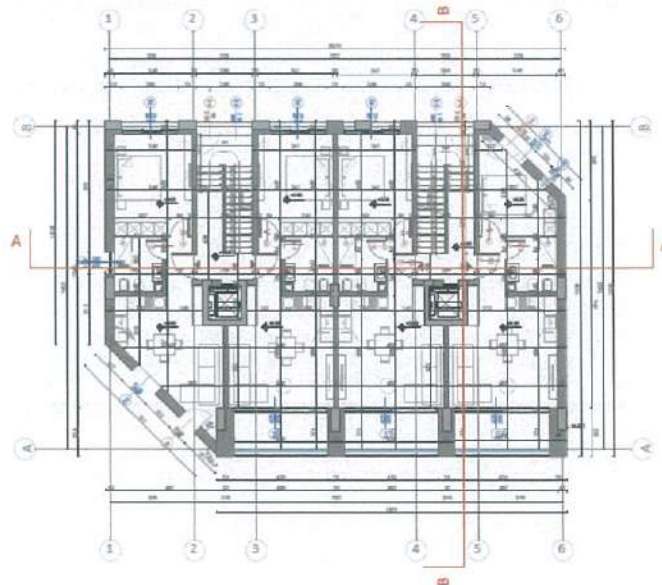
Planimetria e katit përdhe, Objekti 2, Prona Veriore
